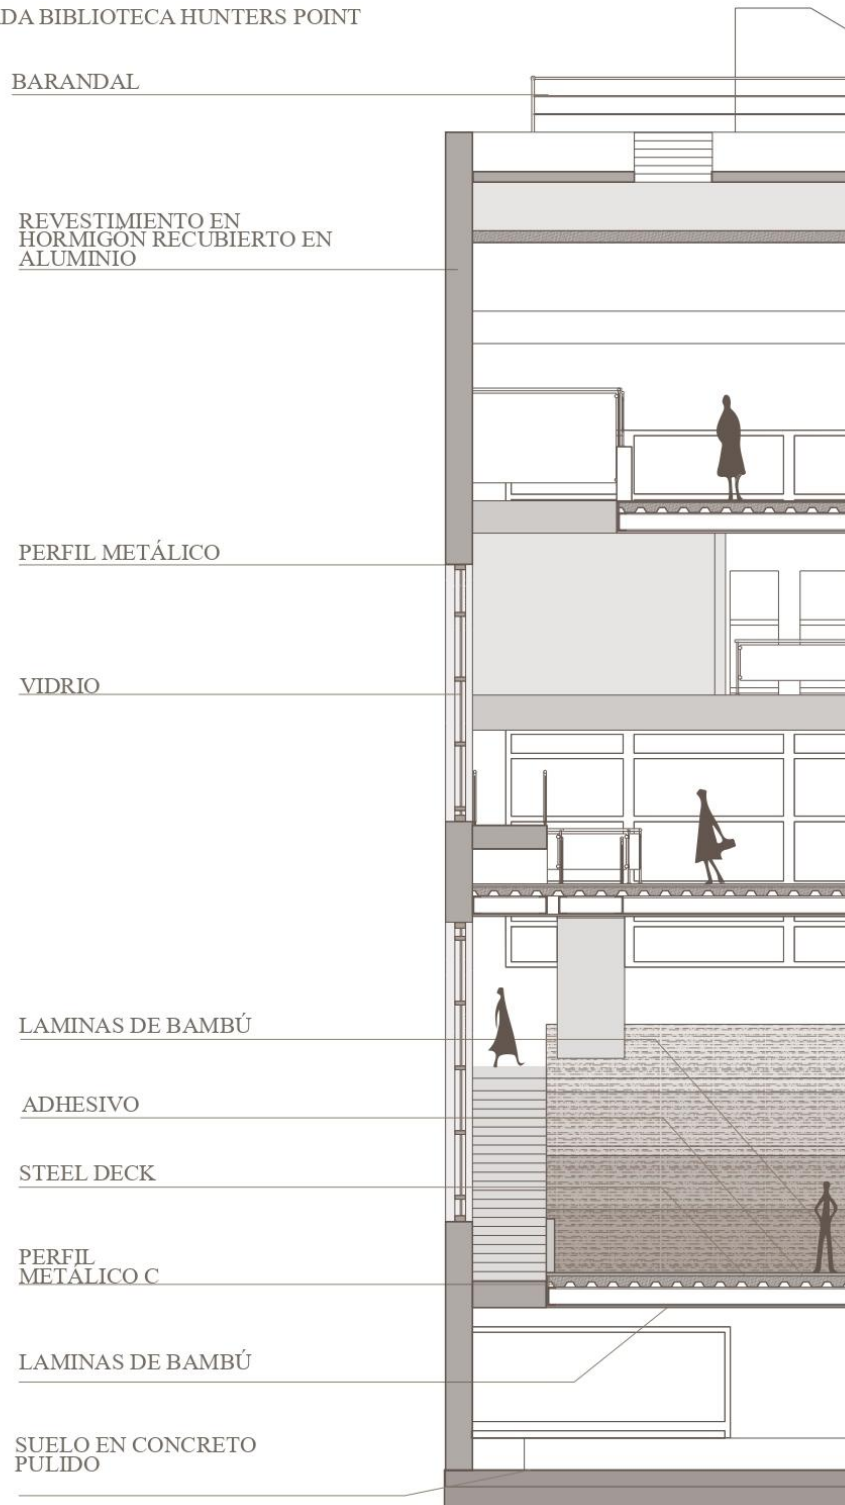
Corte Fachada Biblioteca Hunters Point (Autoría Propia 2025)
